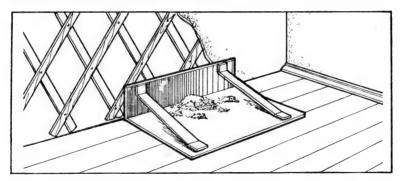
Приспособление для сбора штукатурного раствора в процессе работы
